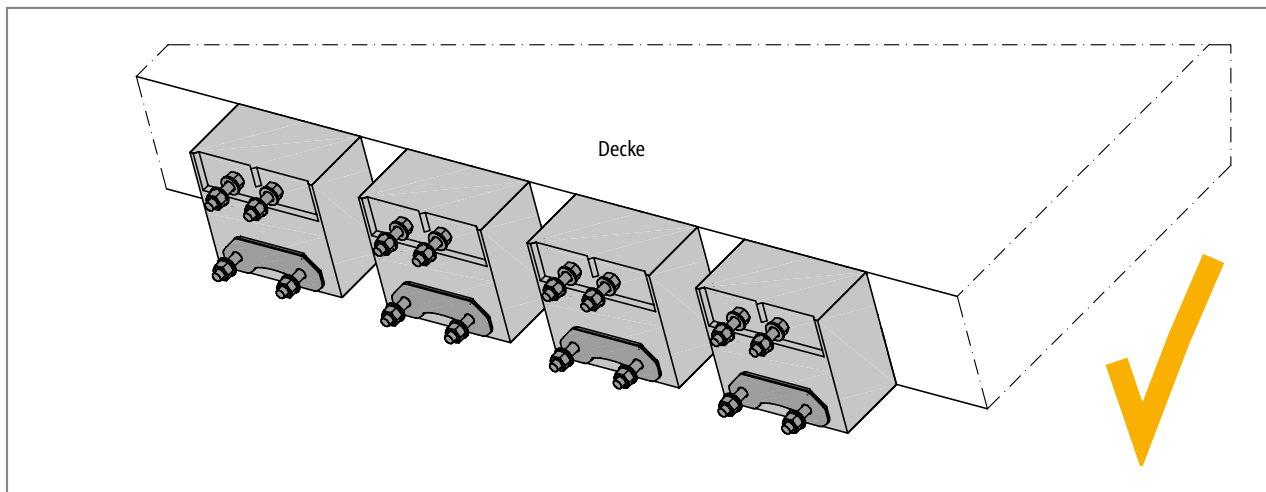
Schöck Isokorb®: Zuverlässige Lagesicherung während des Betonierens ermöglicht das Erreichen der erforderlichen Einbaugenauigkeit
